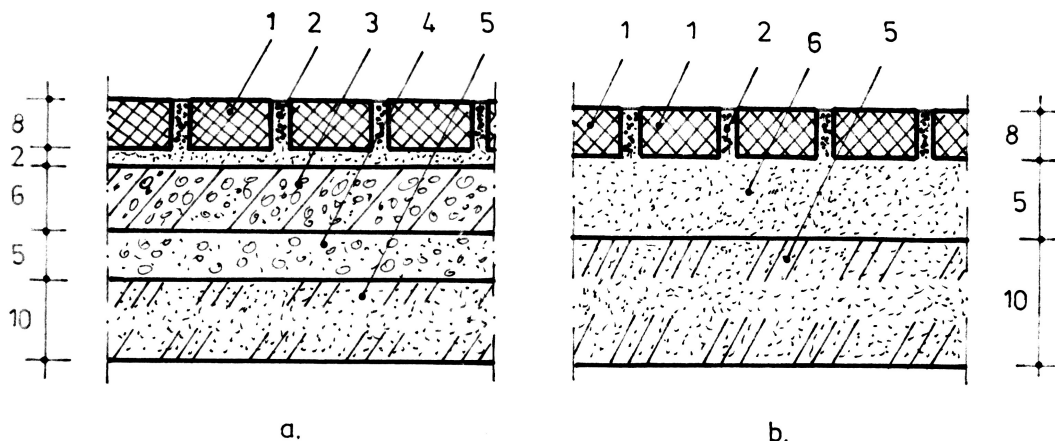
Pardoseli din dale prefabricate de beton:
